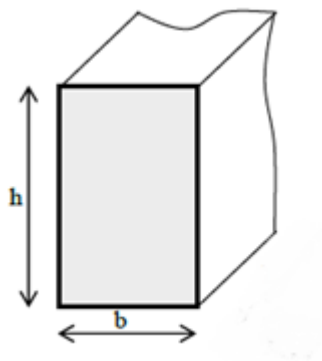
COUPE TRANSVERSALE D'UNE POUTRE PRINCIPALE
